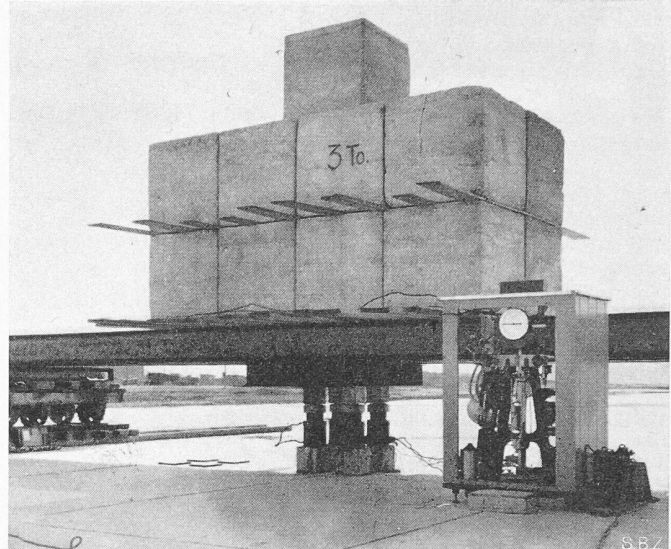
Kontrollbelastungsversuch mit 67,5 t Einzellast auf Betonbelägen der fertigen Westpiste
